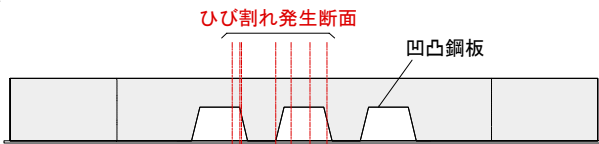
凹凸板タイプ試験体のひび割れ発生位置
